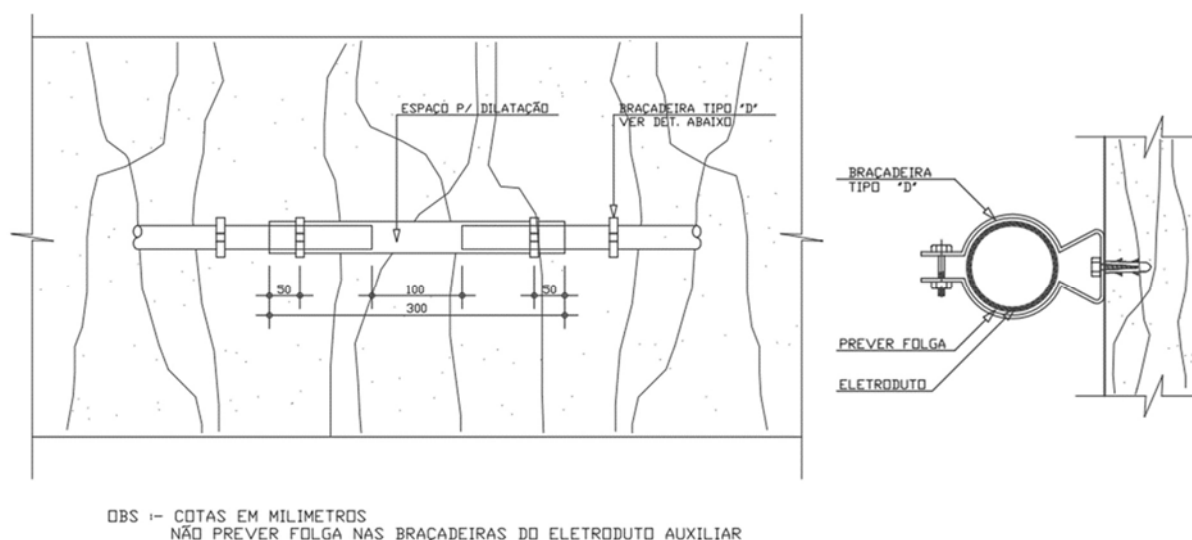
Emenda de eletrodutos de PVC em instalações externas
